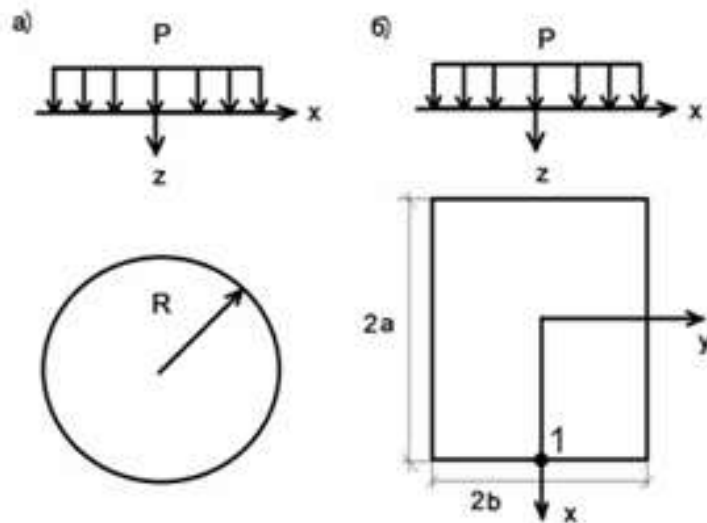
Расчетная схема определения деформированного состояния оснований фундаментов: а) круглой формы, б) прямоугольных.
